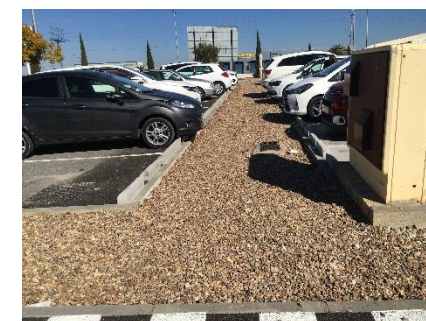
Zanja drenante en aparcamiento, Alcalá de Guadaira.
